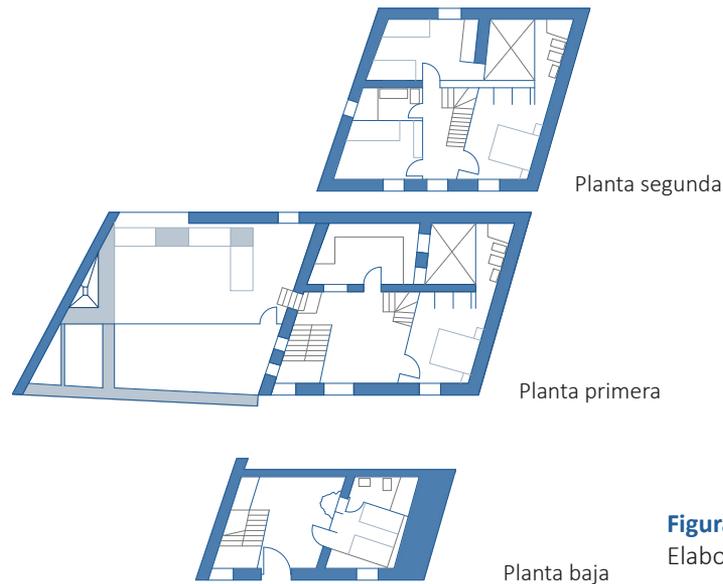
Planimetría Villa Gloria. Elaboración propia.
